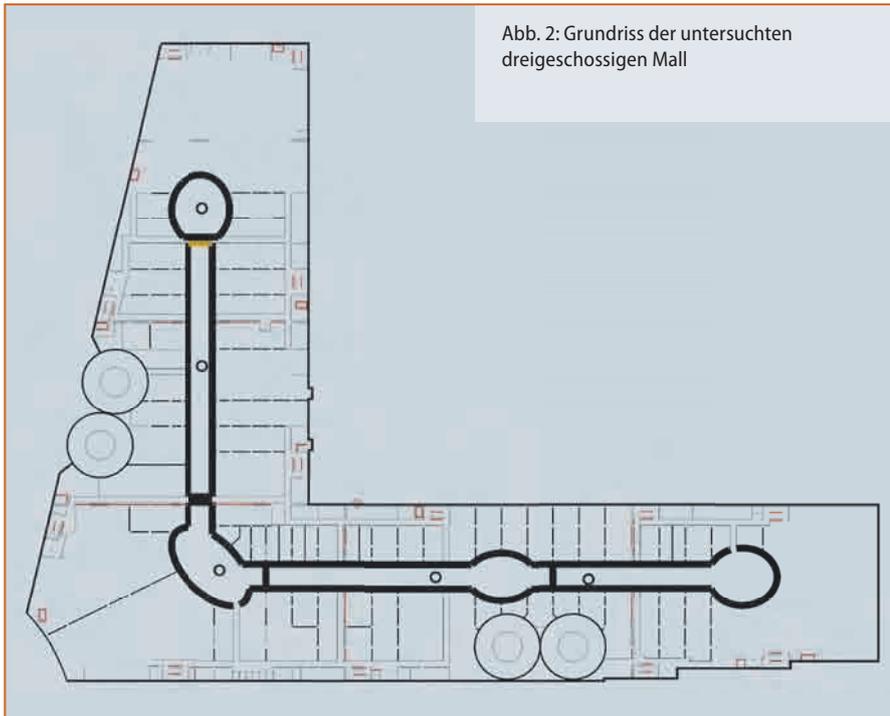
Grundriss der untersuchten dreigeschossigen Mall
